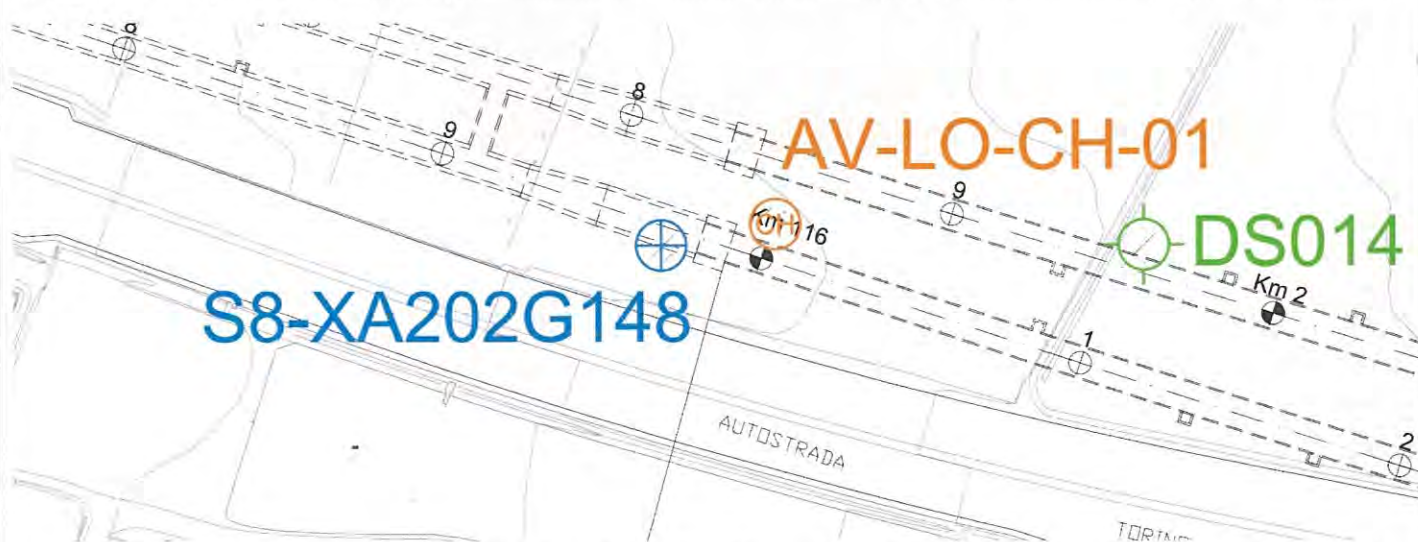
Stralcio planimetrico con l’ubicazione dei sondaggi in corrispondenza dell’imbocco lato Milano della galleria naturale.
